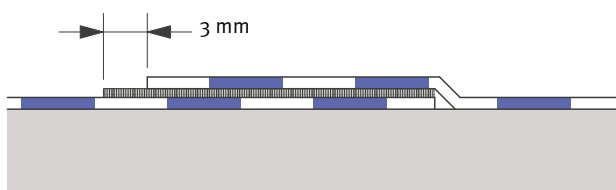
Joint de recouvrement avec bande de butyle autocollante (dépassement de 3 mm).
